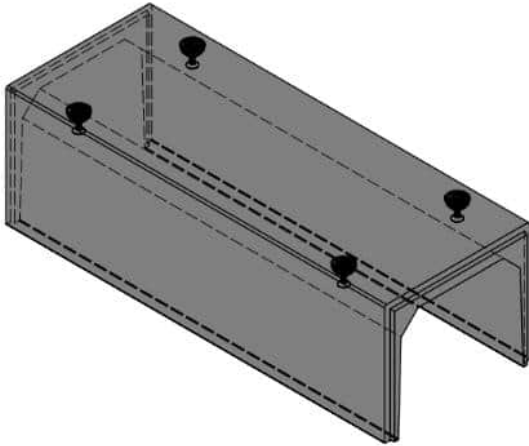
Isometrie Beton-U-Schalenelement
